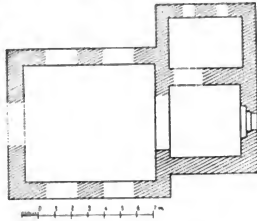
Chodeč. Grundriss der Kirche.
